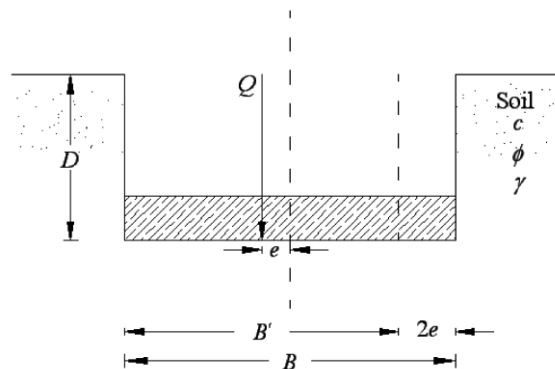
Fondation chargée excentriquement (Meyerhof, 1953)
